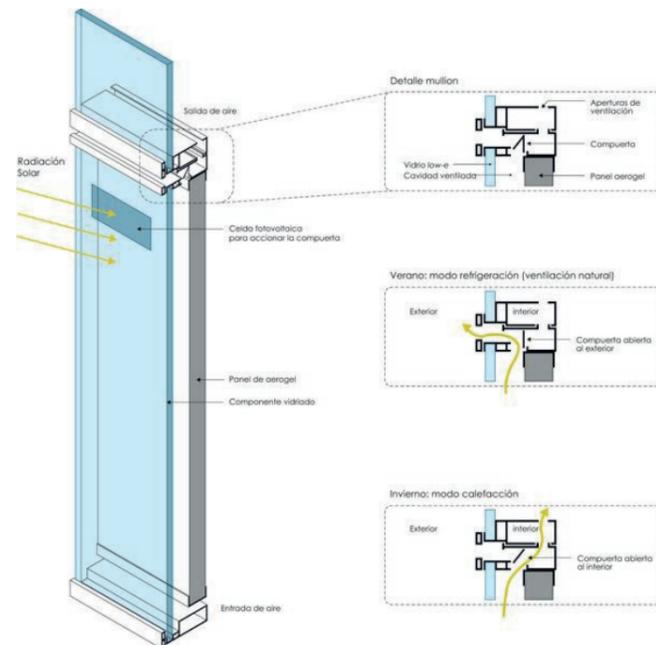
Detalle funcionamiento y composición del sistema Muro Cortina
